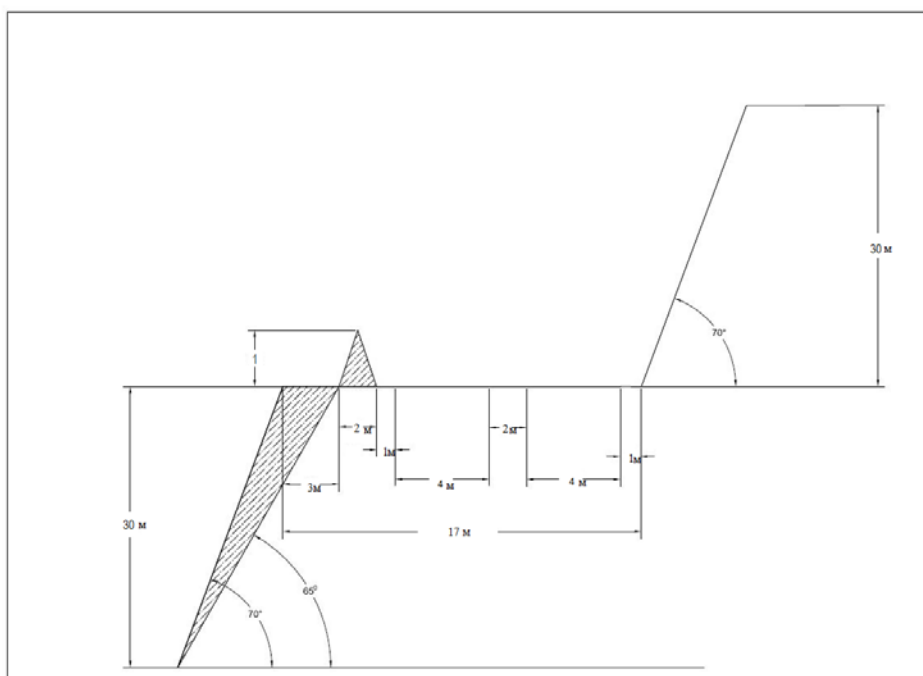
Поперечный разрез капитального съезда
